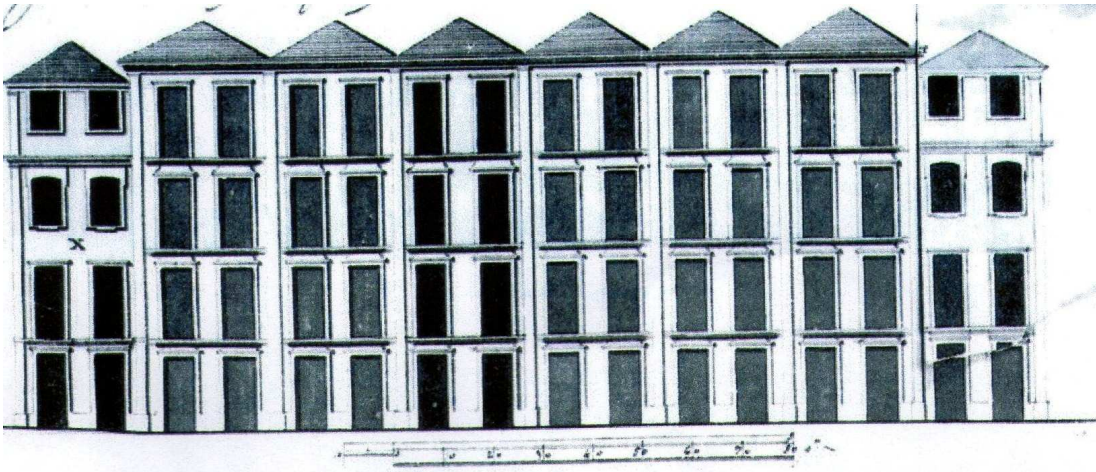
Alçado para as casas da Praça dos Ferradores - (Segunda metade de planta geral do lado do Norte) (Berrance, 1993, p. 56).
